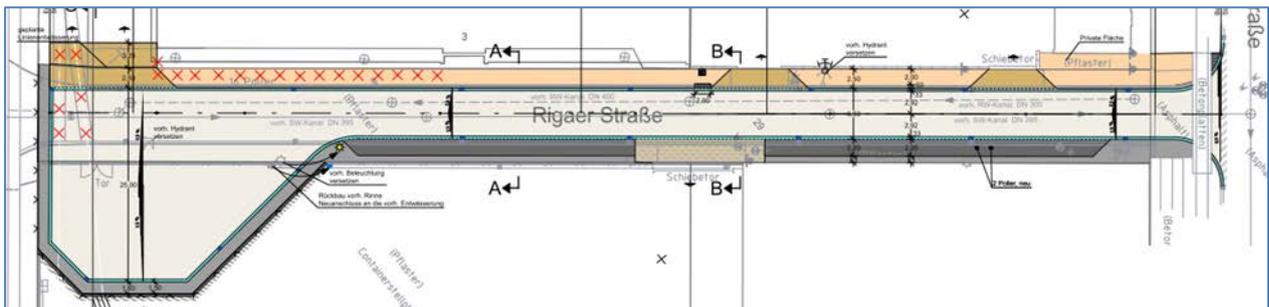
Sanierte Rigaer Straße mit neuer Wendeanlage
